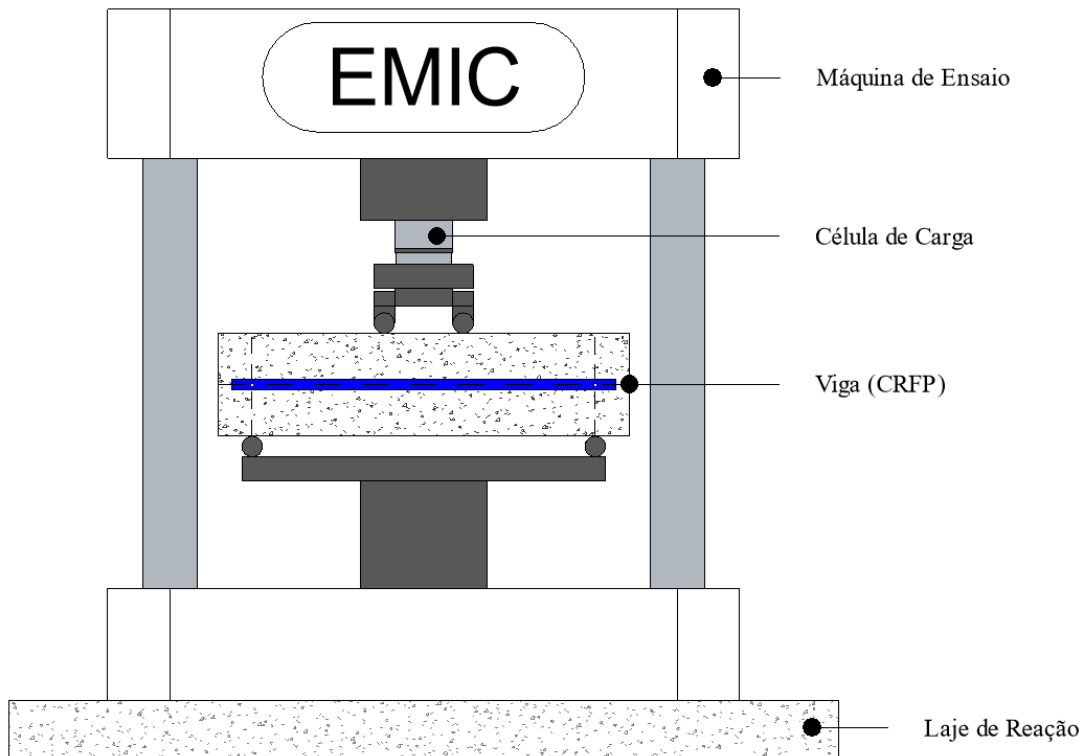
Sistema de ensaio de 4 pontos para vigas (Unidades em milímetros).
